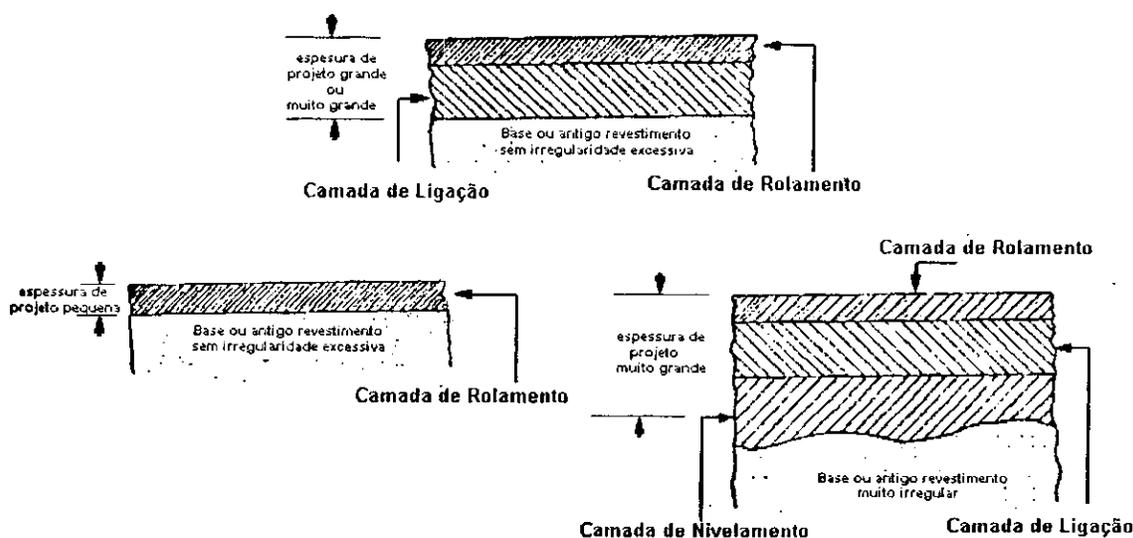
Tipos de Utilização do Concreto Asfáltico
